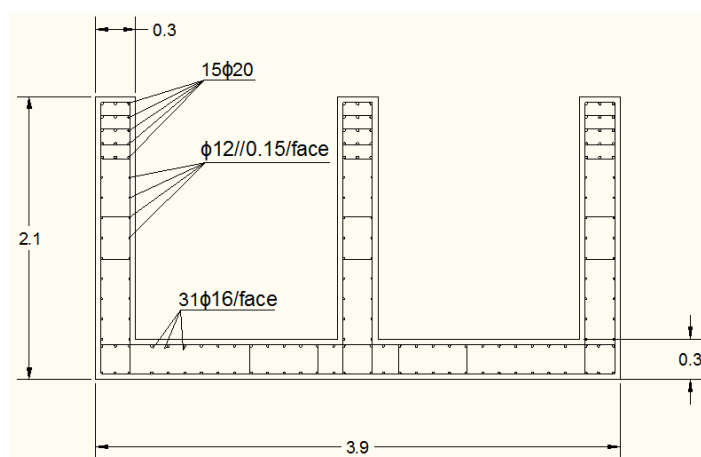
Disposição de armaduras - Caixa de elevadores
